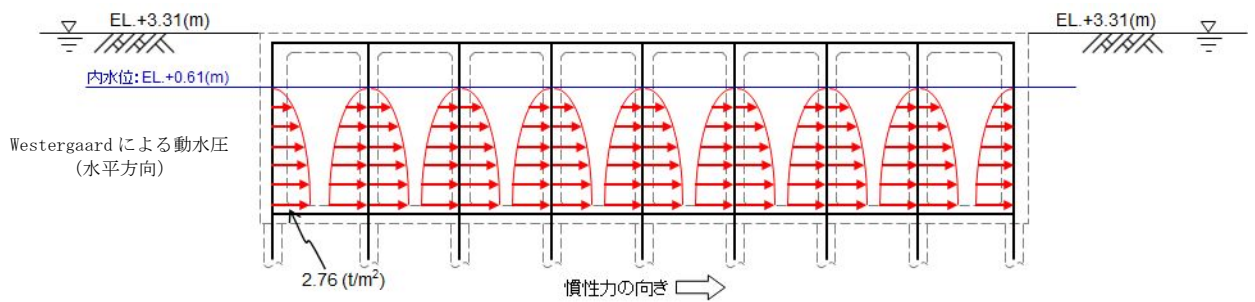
(1) 水平動による動水圧図 (①-①断面)
